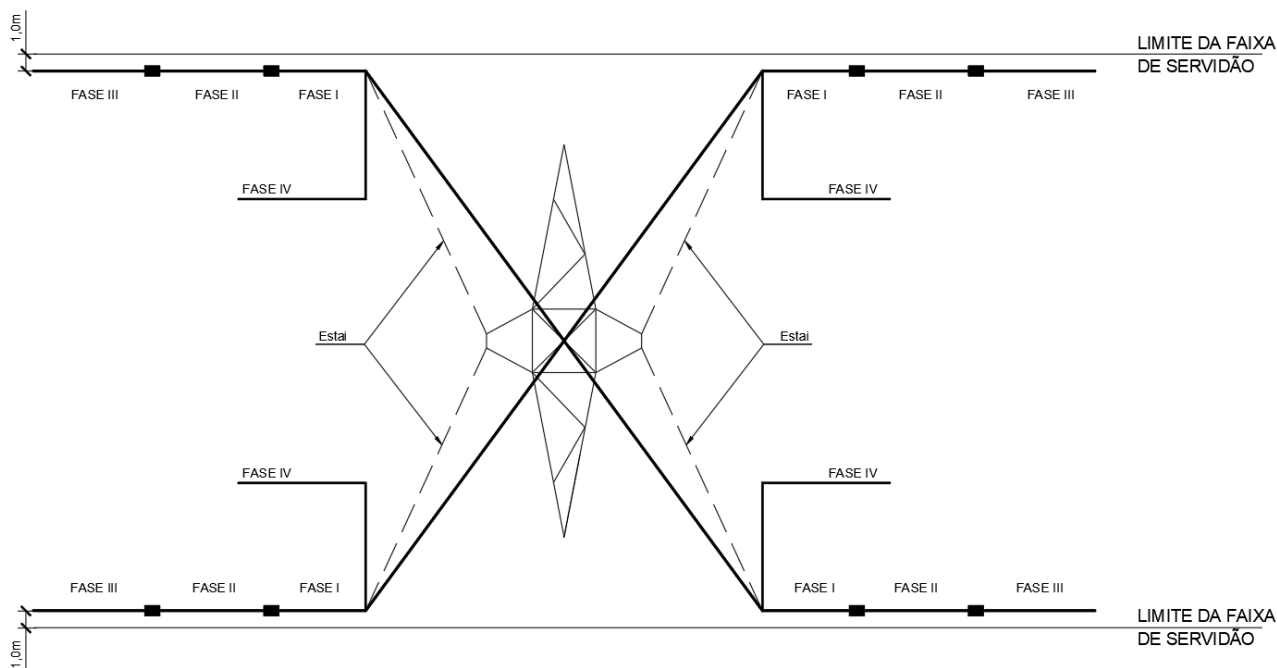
Configuração do sistema de aterramento proposto para estruturas estaiadas
